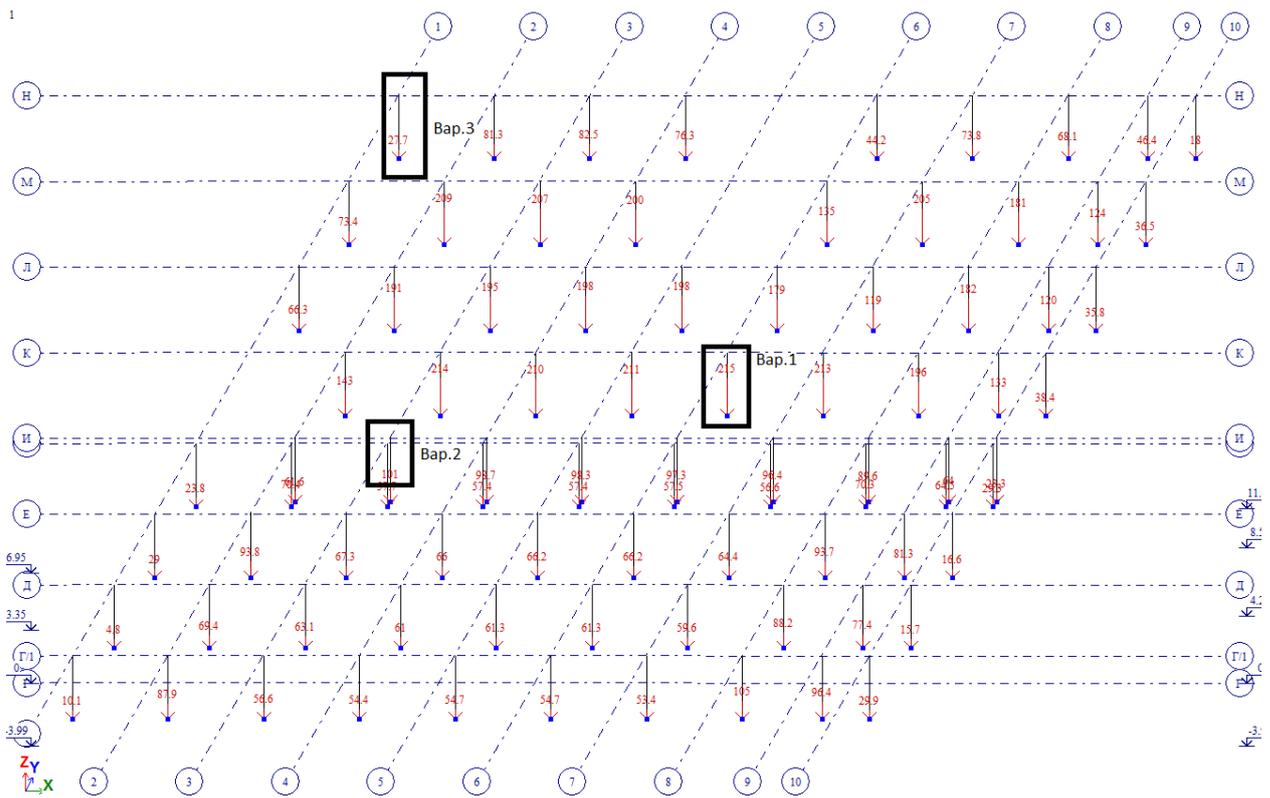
Сила  $P_z$  для расчета фундаментов
